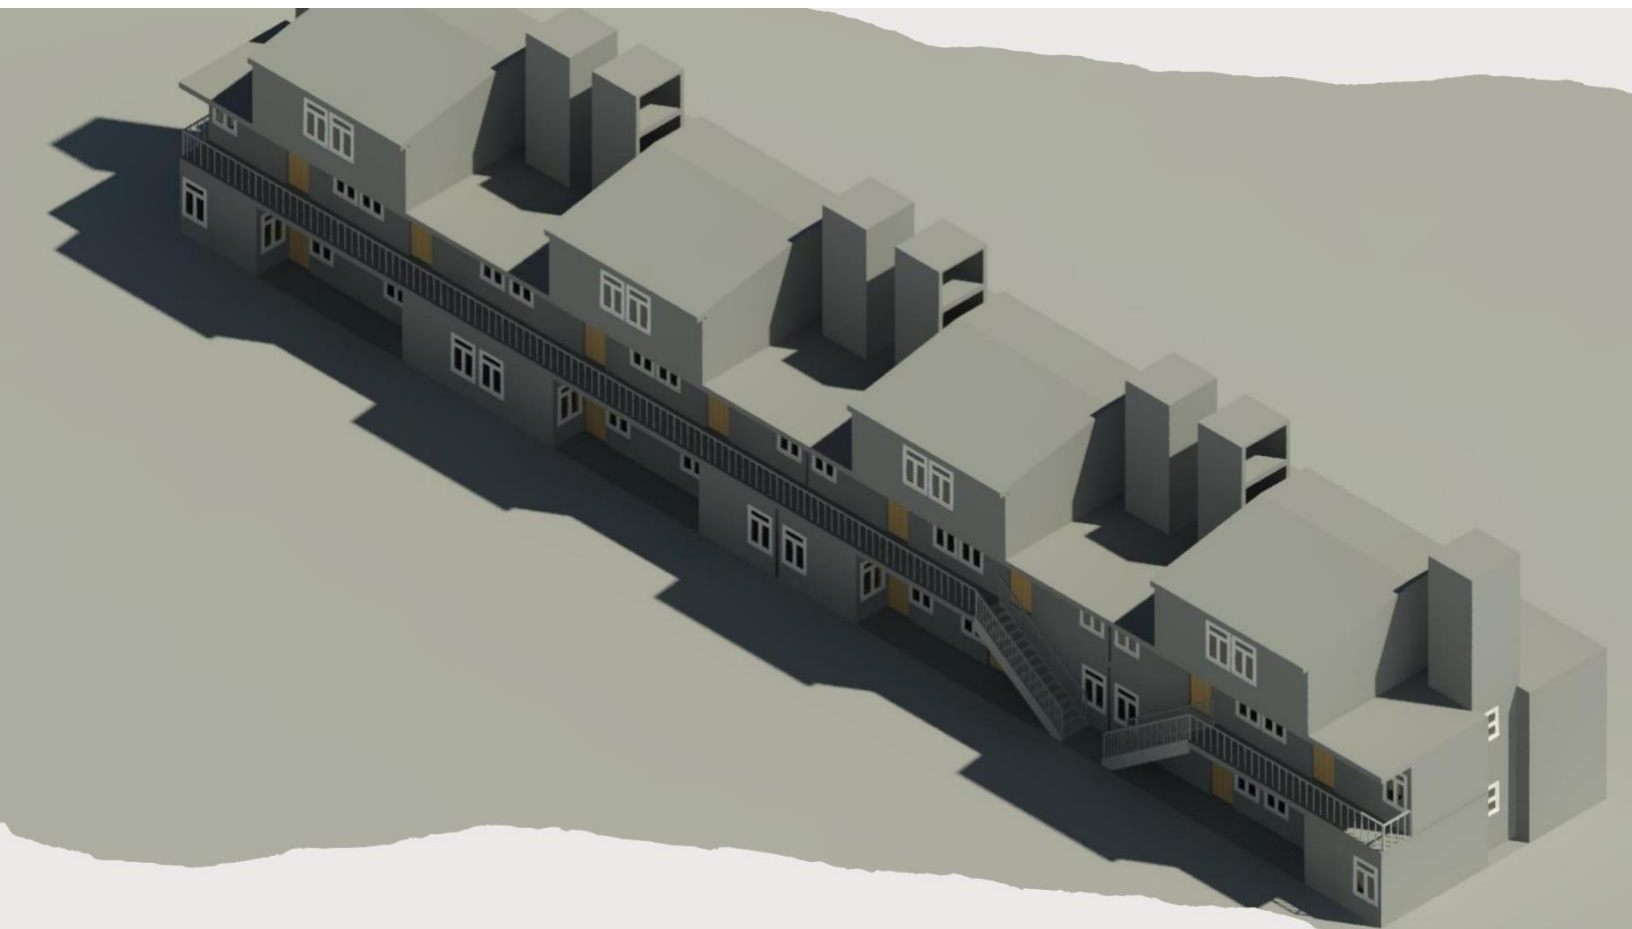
Modelo arquitectónico – Proyecto Palo Alto
